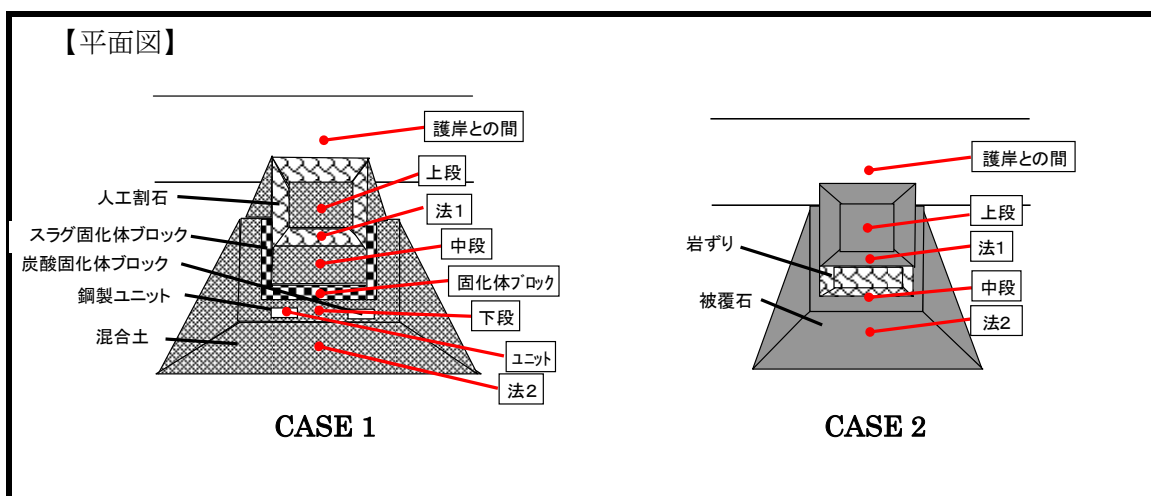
実証対象技術の配置及び試料採取位置 (平面図)
